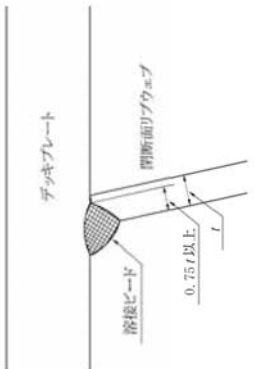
縦リブとデッキプレートの溶接の溶込み量
